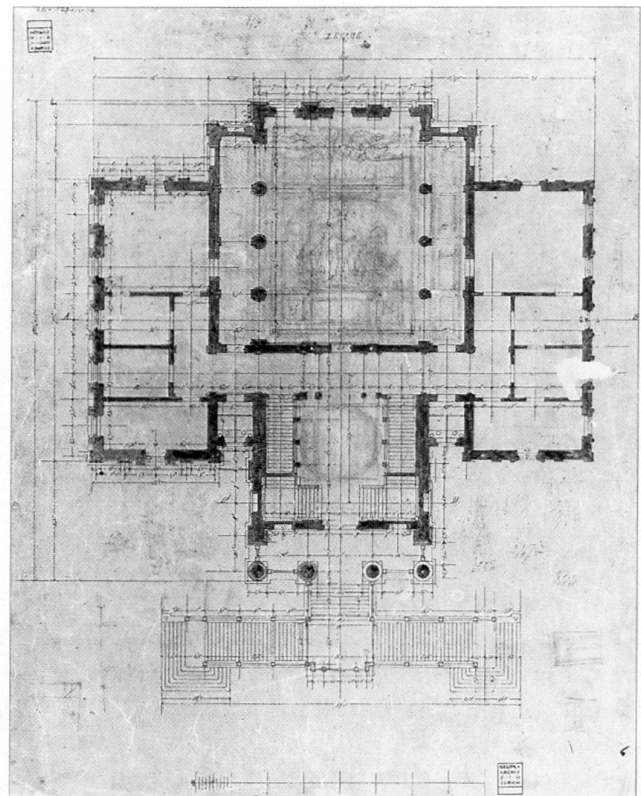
Winterthur, Stadthaus. Grundriss des ersten Stockes mit skizziertem Deckenschmuck. Werkplan von Gottfried Semper (1803–1879), um 1865.
